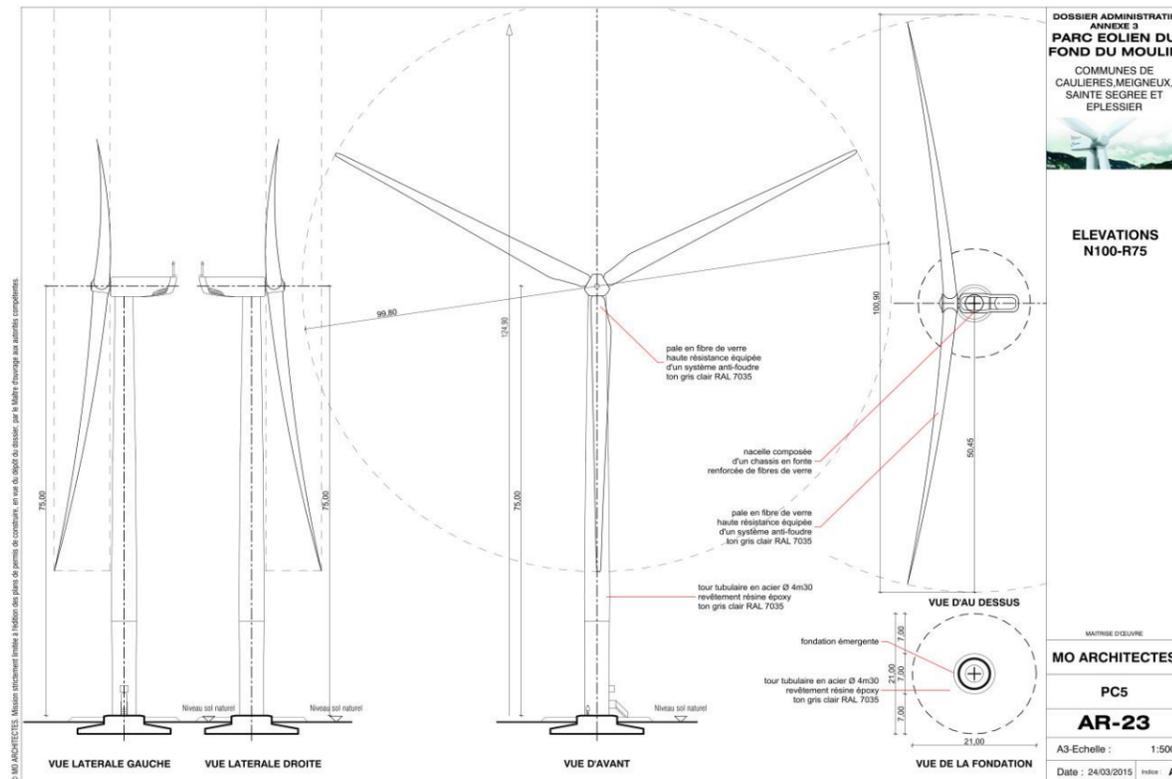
Plan en coupe de l'éolienne NORDEX N100-R75
